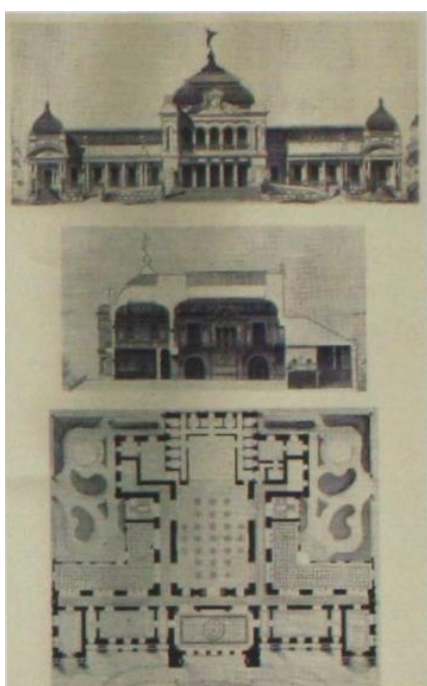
José Pacheco, alçado, corte e planta do projecto de casino, 1907
